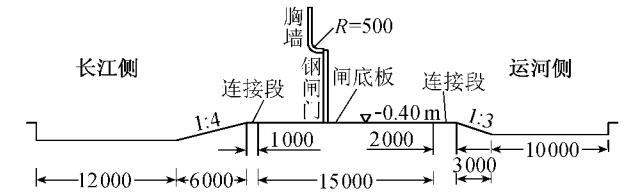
谏壁节制闸闸底板及上下游消力池平面布置示意图(单位:mm)
